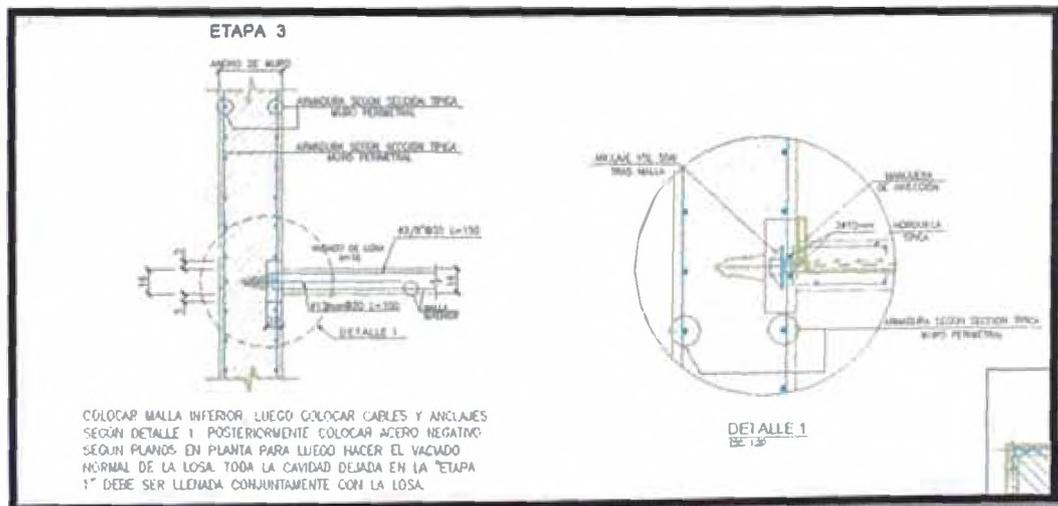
Detalle de refuerzo de anclaje pasivo en muro.
